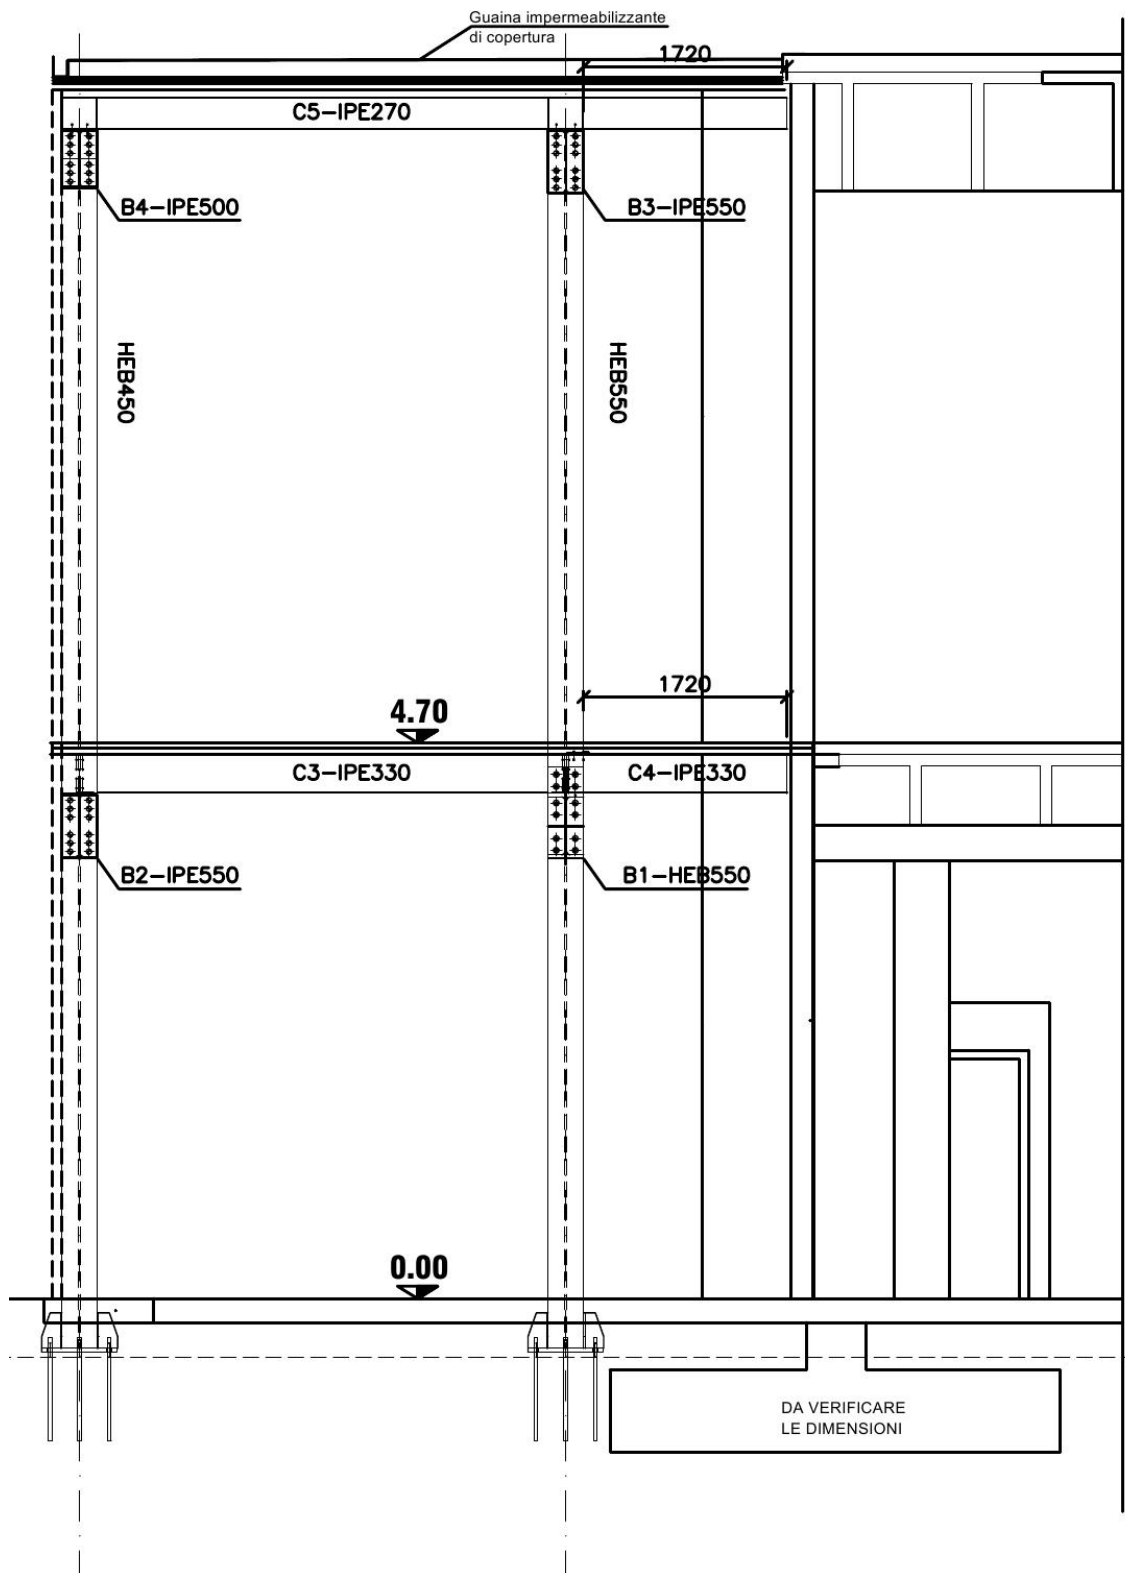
Particolare di A.2009.a.us.T02 - Progetto della struttura metallica - Sezione trasversale tipo
